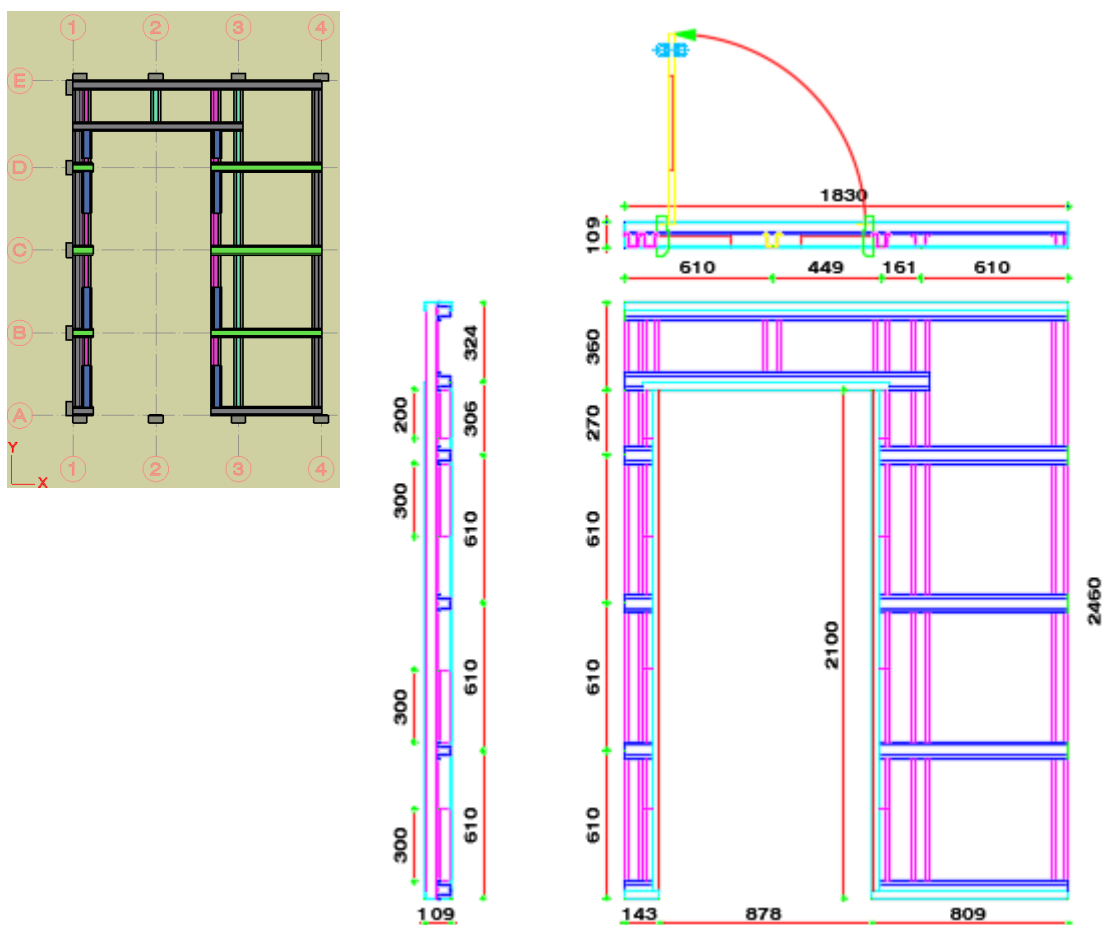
Dimensiones del Panel Puerta de 1.830mm x 2.460mm
